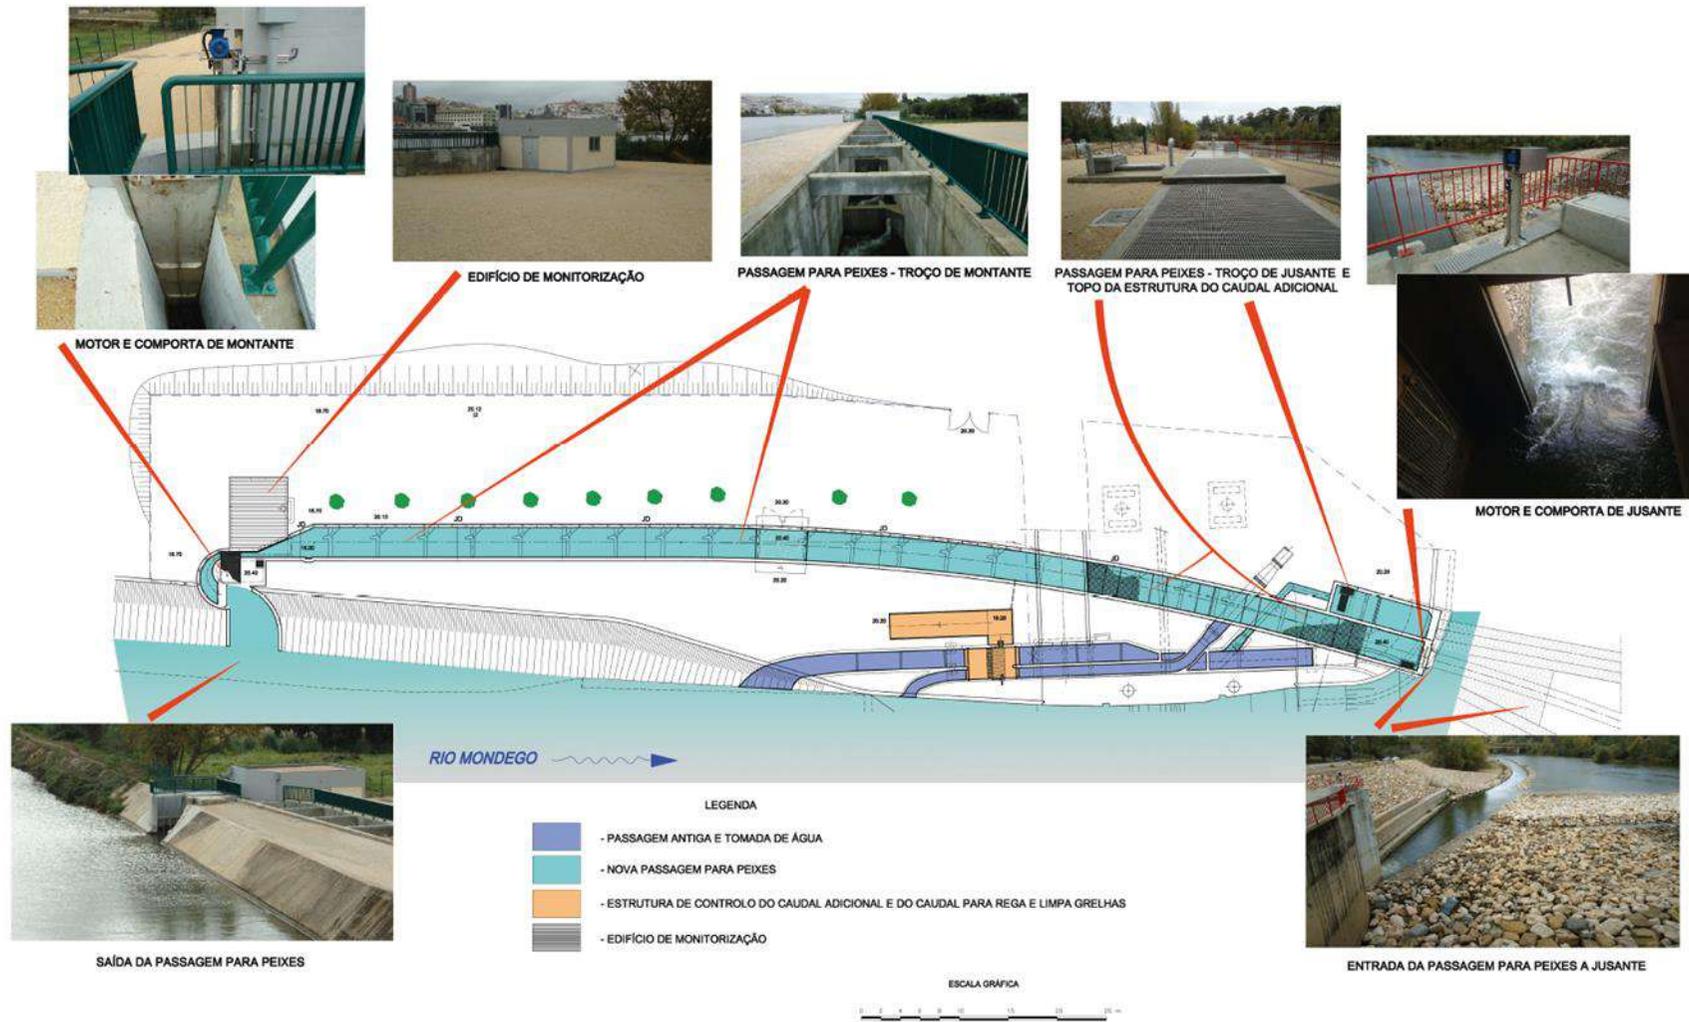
planta e fotos da PPPeixes de Coimbra.
